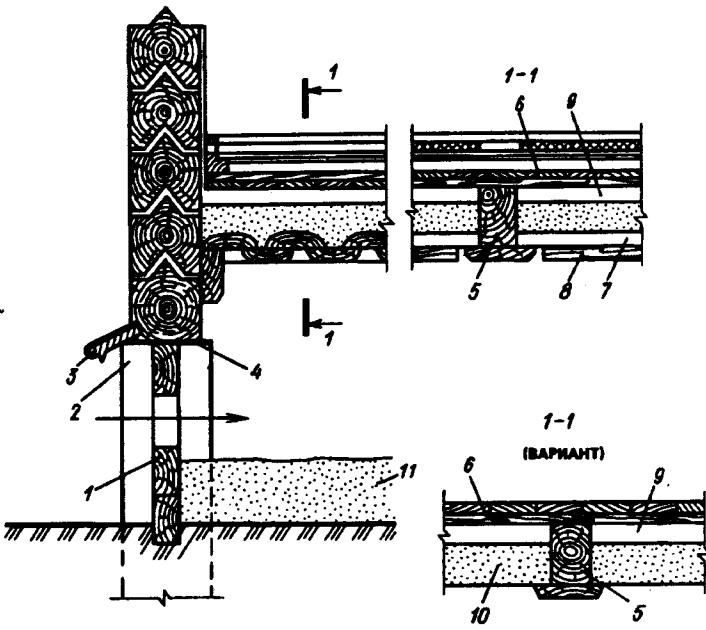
Конструкция утепленного цокольного перекрытия с проветриваемым подпольем
